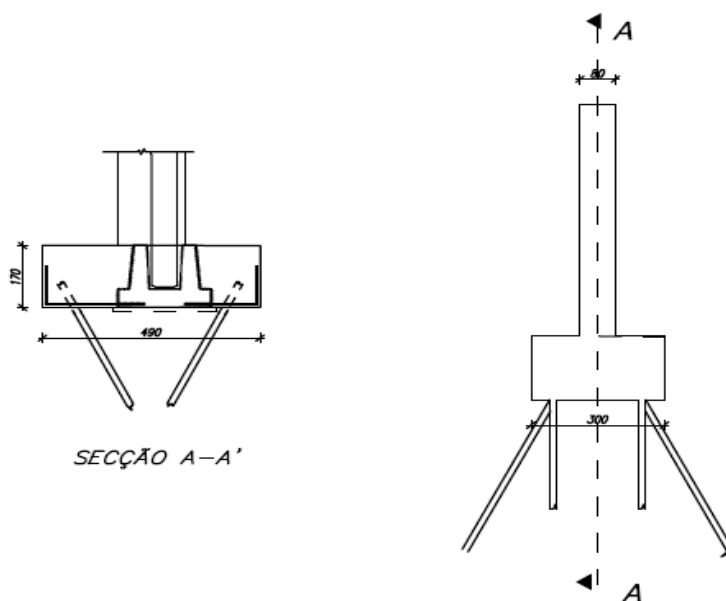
Intervenção de encamisamento com betão armado nos pilares dos grupos 2 e 3
